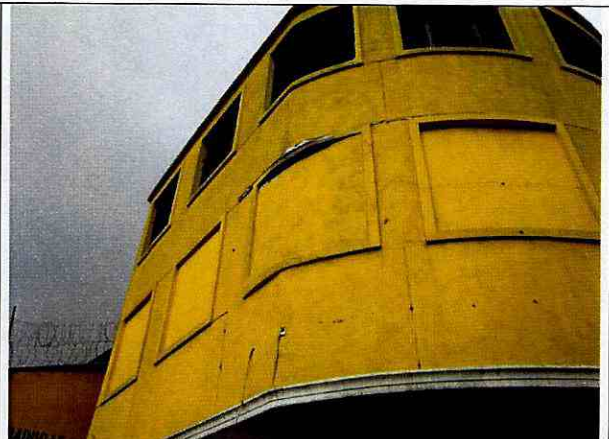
Muros externos con fisuras y deterioro incipiente.
